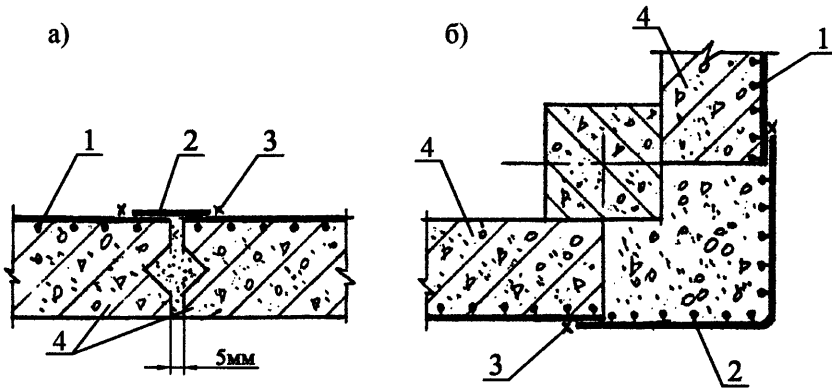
Гидроизоляция из полиэтиленовых листов для сборных конструкций стен
